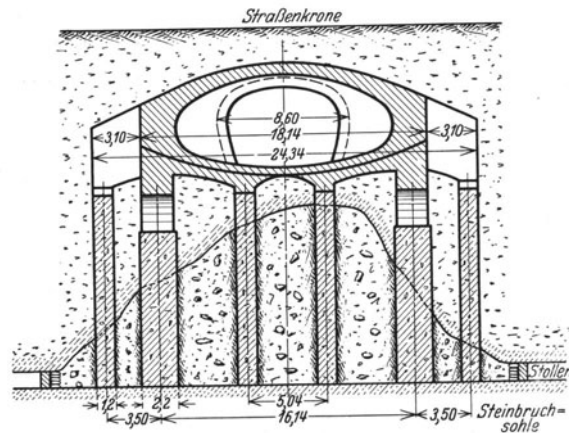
Gründung der Tunnel der Pariser Untergrundbahn im Steinbruchgebiete auf Pfeilern. (Nach E. A. Roth.)
